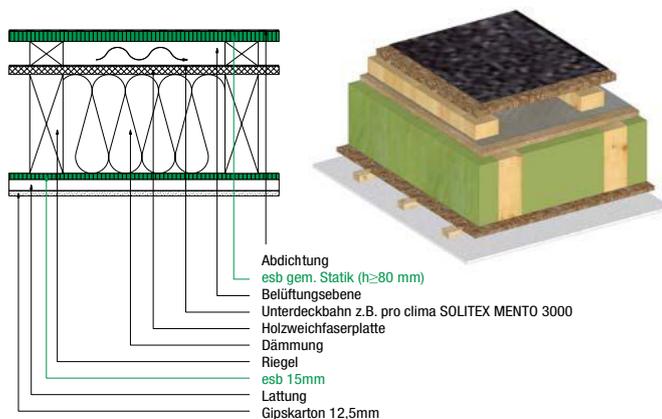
Flachdach mit unterlüfteter Dachhaut
